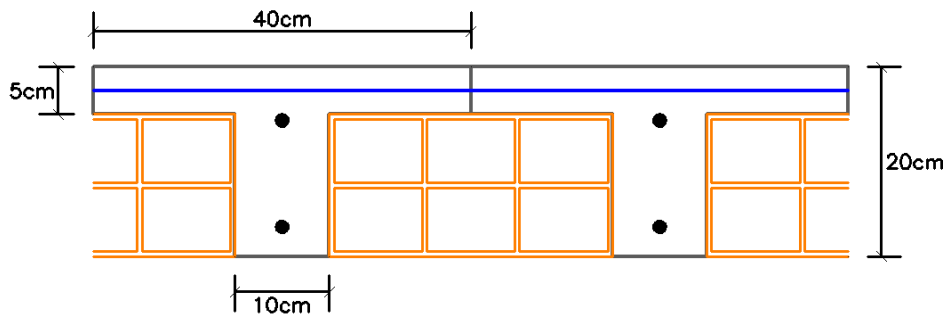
Losa Aligerada Entrepiso 3- Sistema estructural tradicional.
